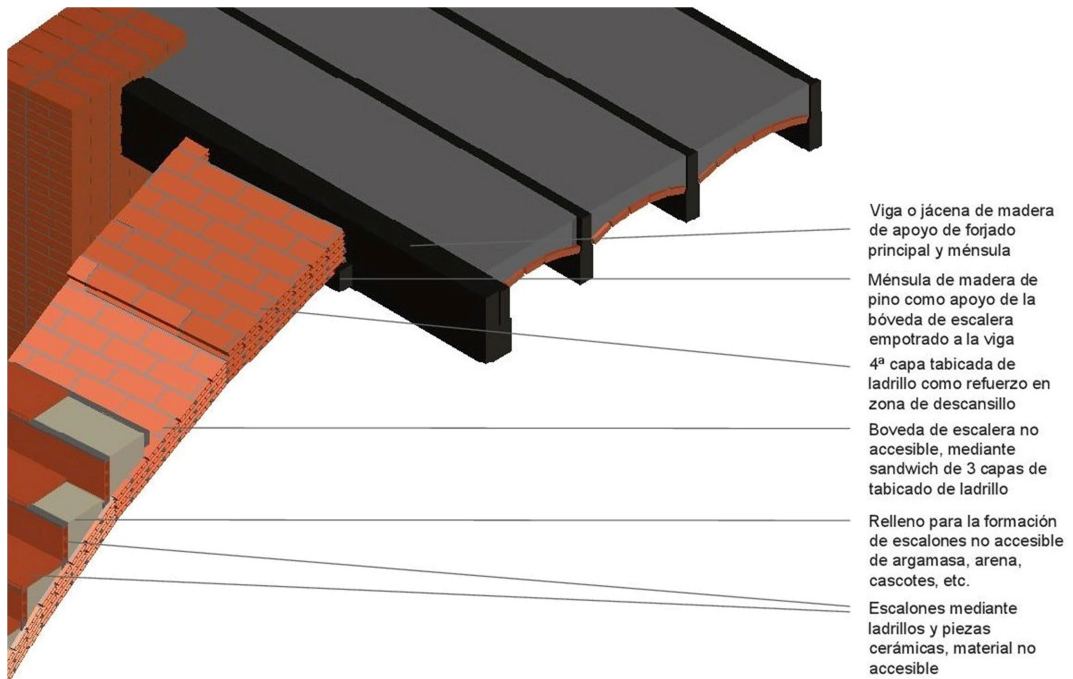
Detalle en secuencia constructiva del encuentro de la estructura de escalera con la estructura de forjado
